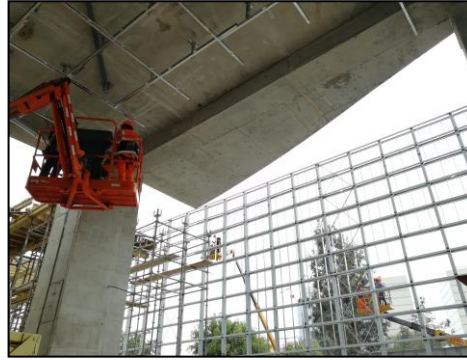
Instalación de perfilería de drywall vertical y horizontal, con refuerzos para previa instalación de planchas, sótano 1.
